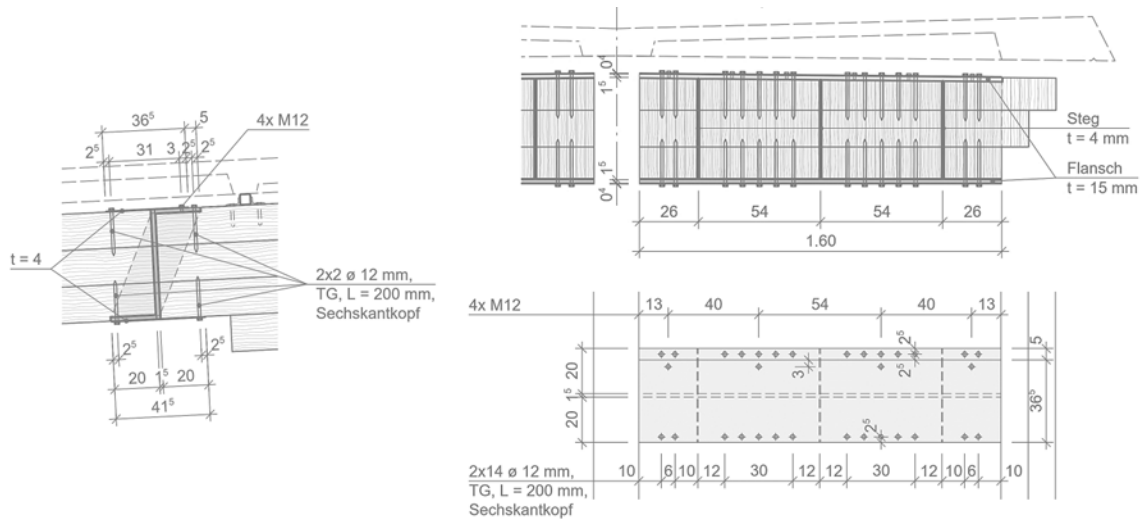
Längsschnitt (links), Querschnitt und Grundriss (rechts) Gerbergelenk 1/5
